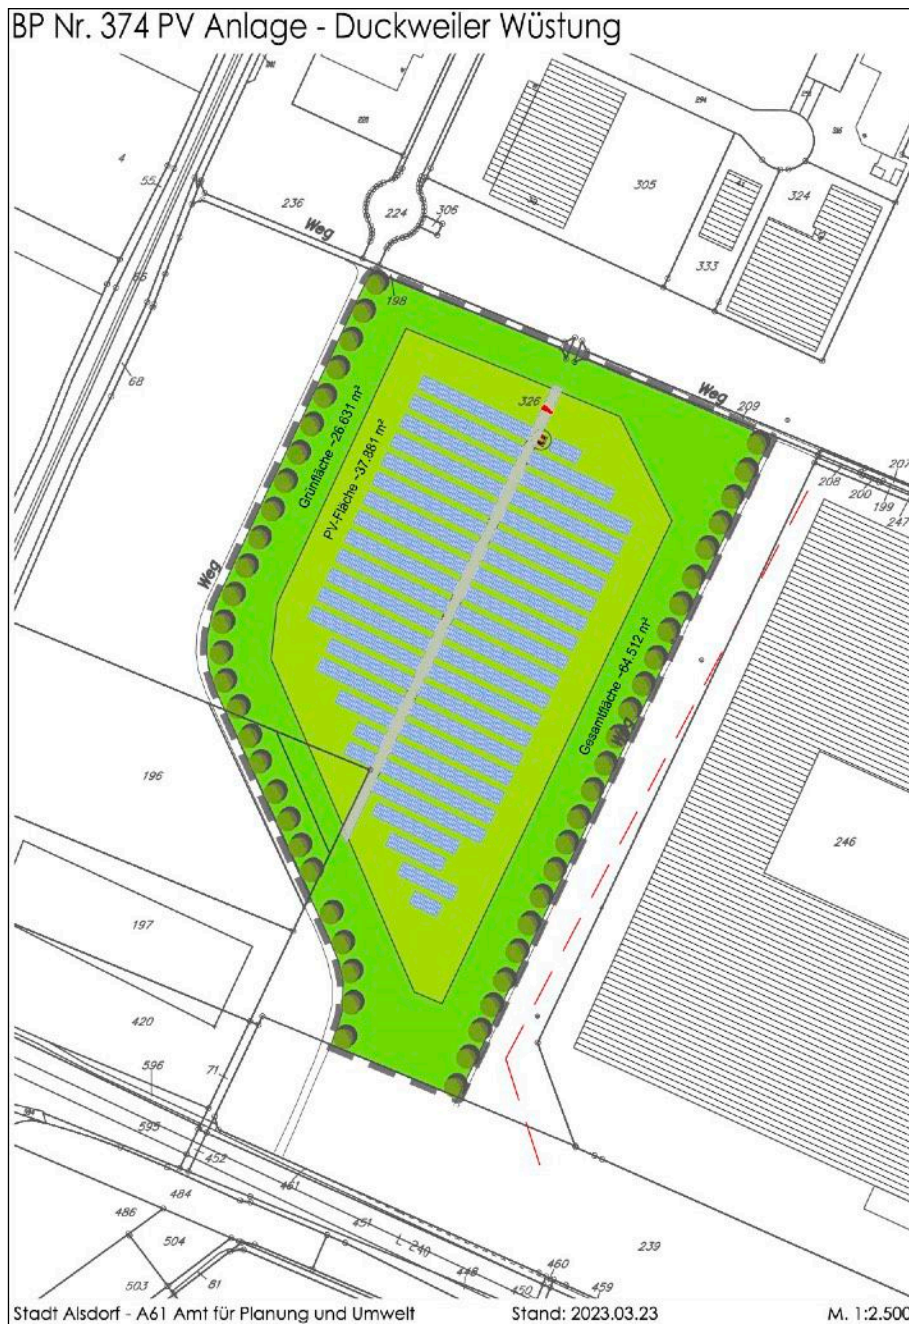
Auszug Städtebaulicher Entwurf Bebauungsplan Nr. 374
